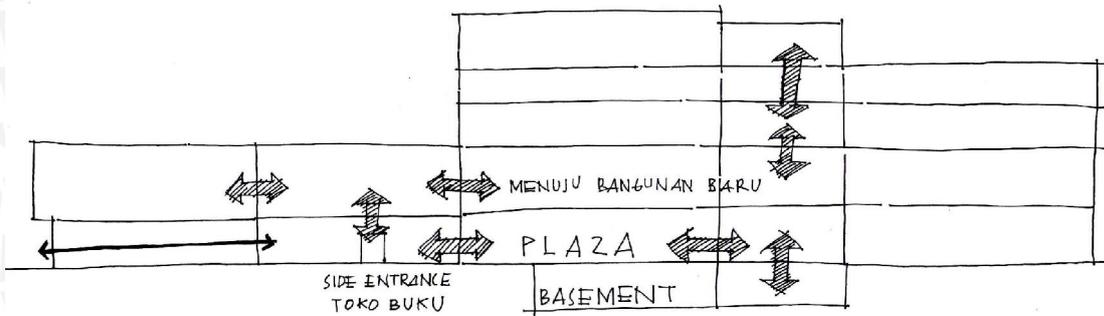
Sirkulasi depan dan belakang bangunan eksisting
